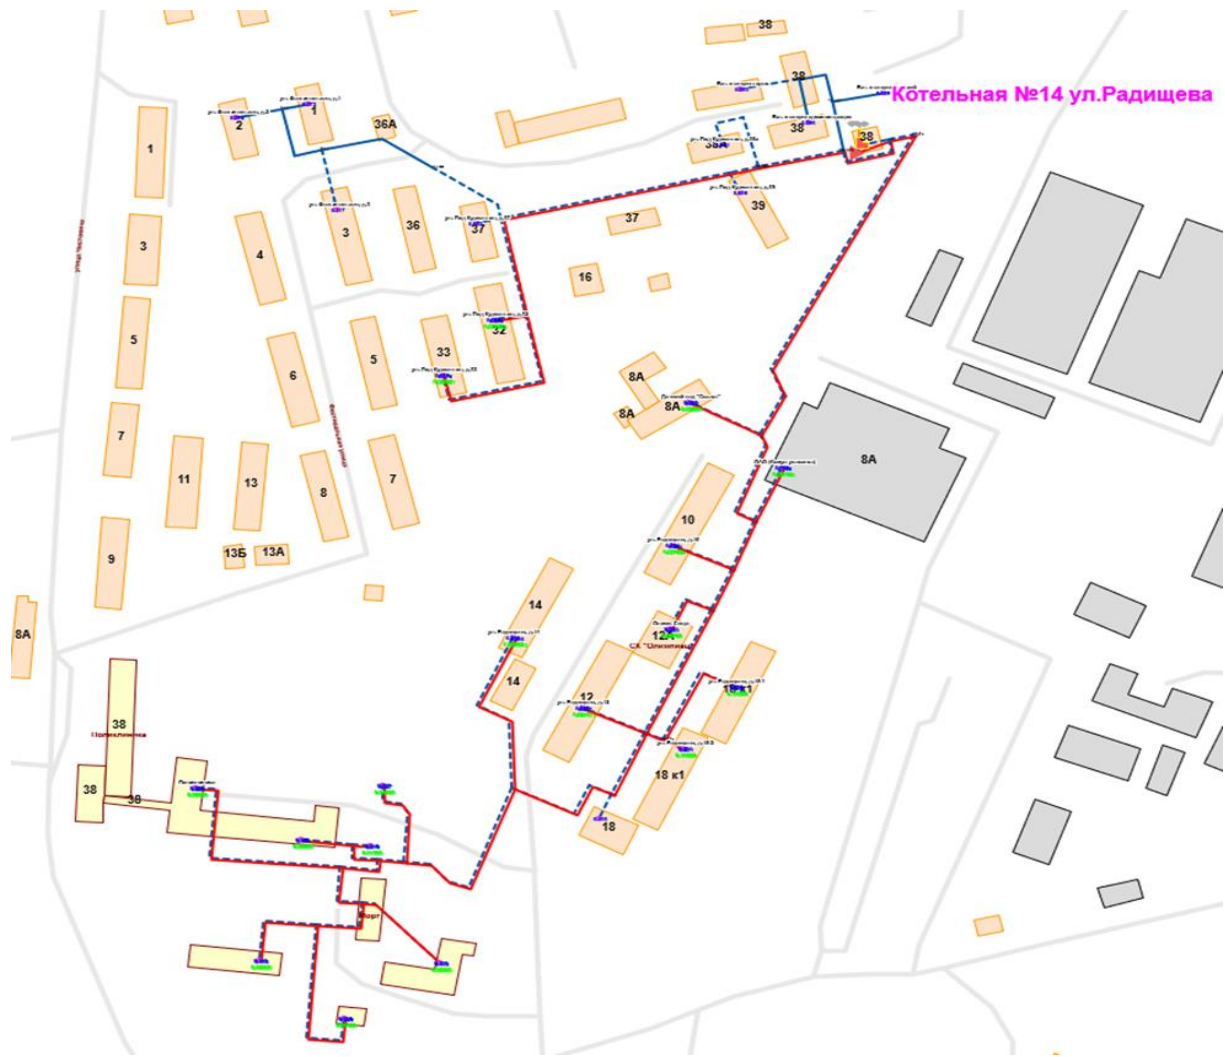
Схема тепловых сетей котельной №14 ул.Радищева
